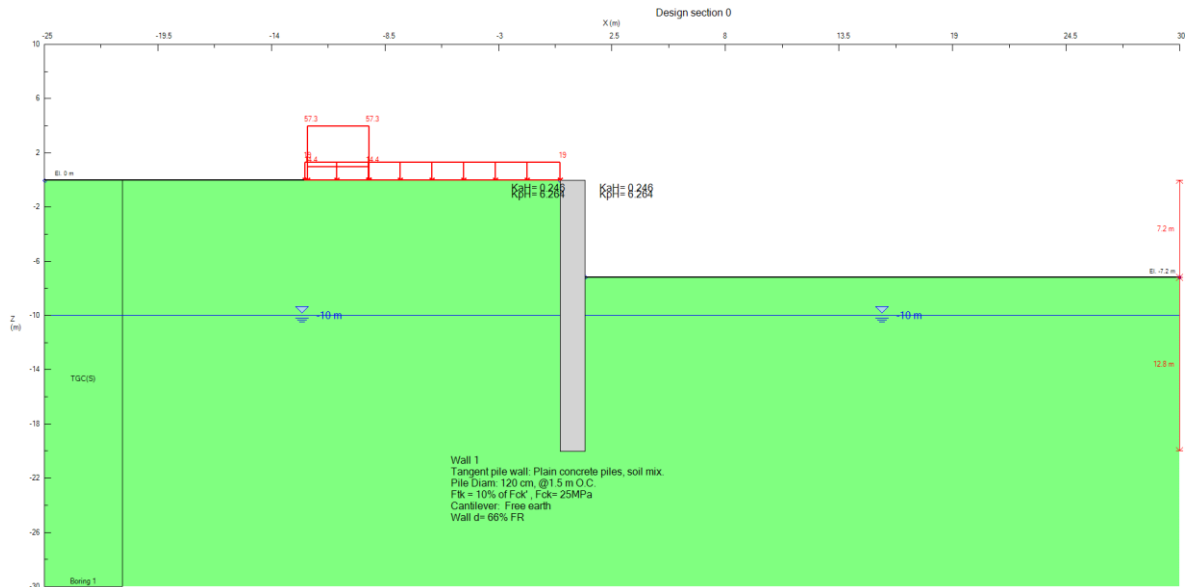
Spalla 2 - sez.2: Modello di calcolo: STEP 1
